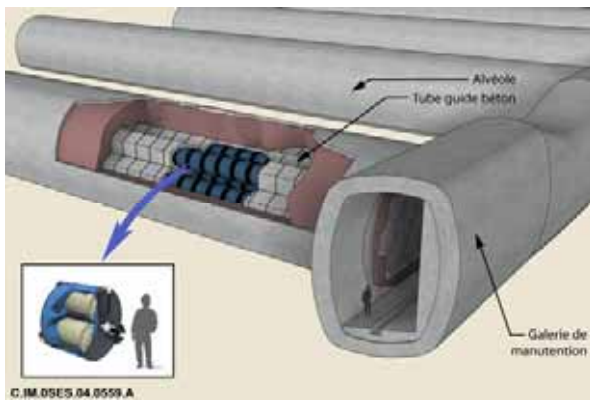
Tunnel avec tubes guides horizontaux
